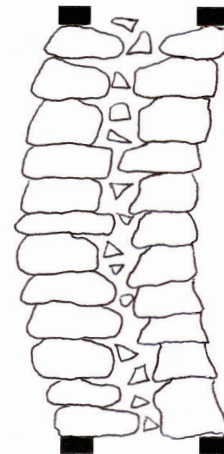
Schéma : déformation hors plan d'un segment de maçonnerie, permise grâce à la présence des tasseaux longitudinaux.
